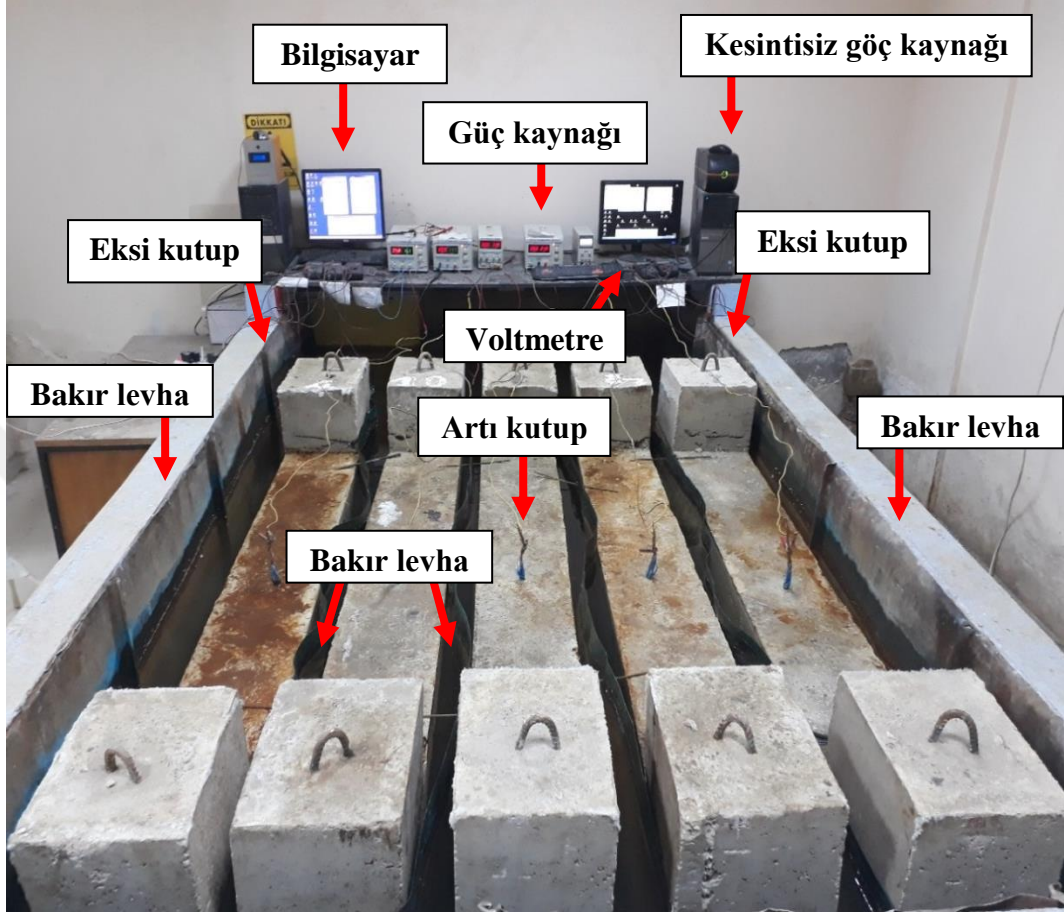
Betonarme kolonlarının paslandırma havuzuna taşınması.
